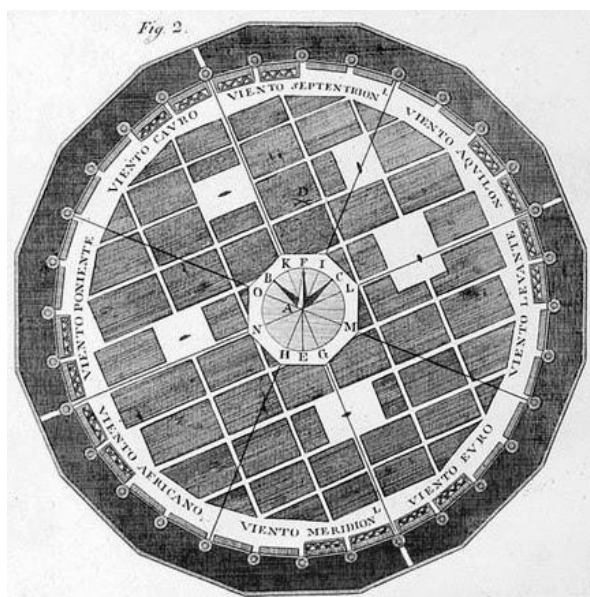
Planta de una ciudad resguardada de los vientos, según la reconstrucción de Don José Ortiz. Lámina 1, figura 2
